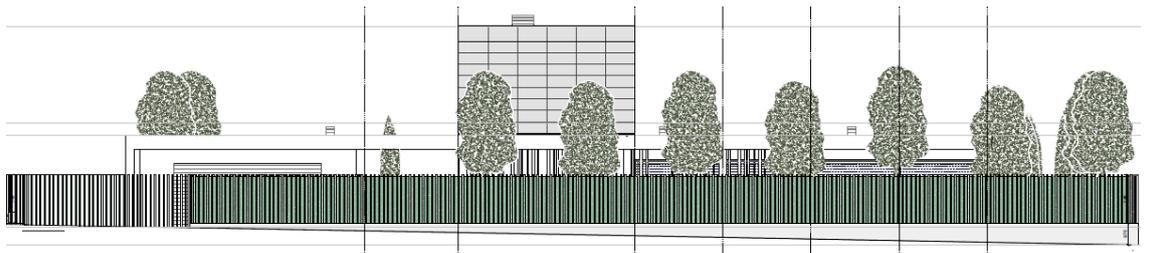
Alzado oeste. 2019. Planos del Proyecto
